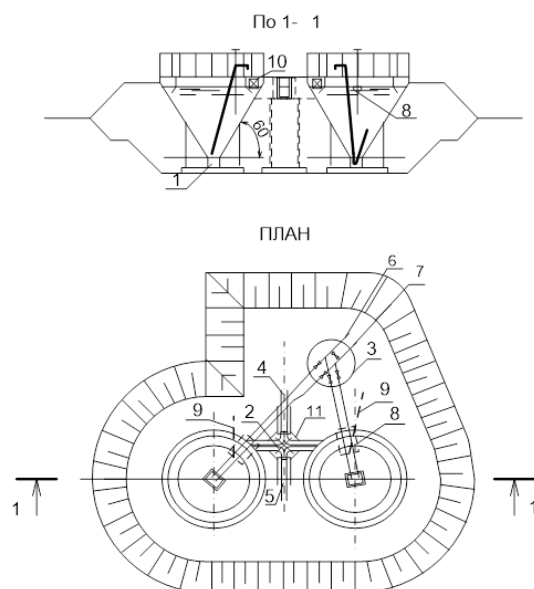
Горизонтальная песколовка с круговым движением воды: 1 - гидроэлеватор; 2 - щитовой затвор; 3 - камера переключения; 4 - подводящий лоток; 5 - отводящий лоток; 6 - пульпопровод; 7 - трубопровод рабочей воды; 8 - устройство для сбора нефти; 9 - нефтепровод; 10 - полупогруженный щит; 11 - распределительная камера.
